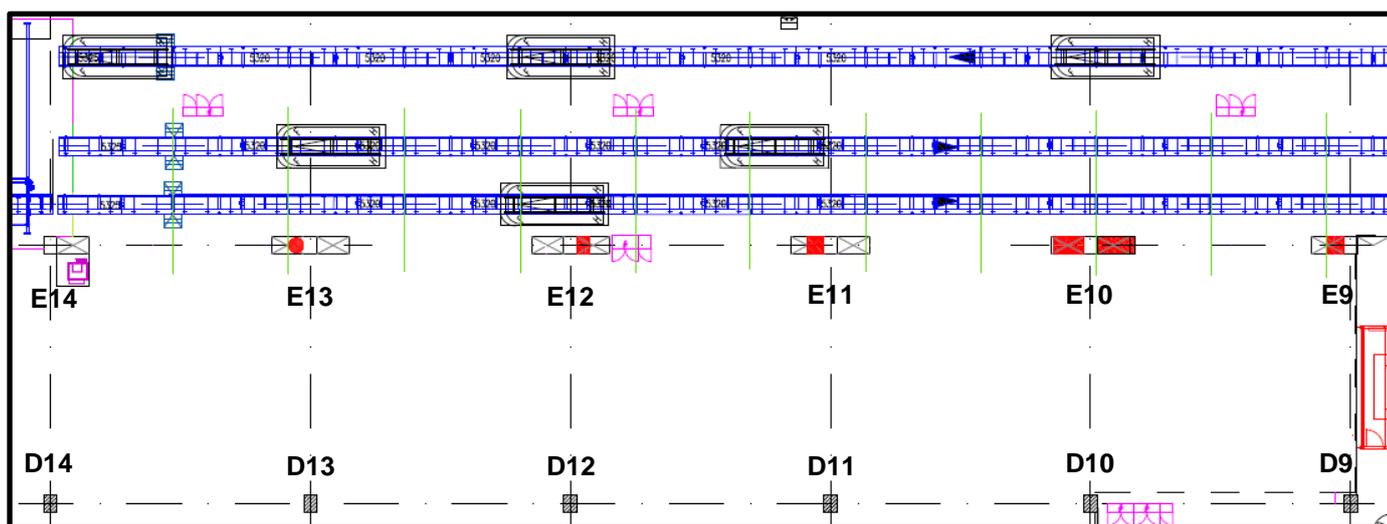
Plano emplazamiento instalación: conductos de ventilación y límite de mesas
